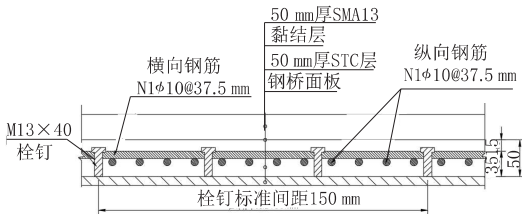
钢箱梁桥面铺装构造示意图(单位:mm)
